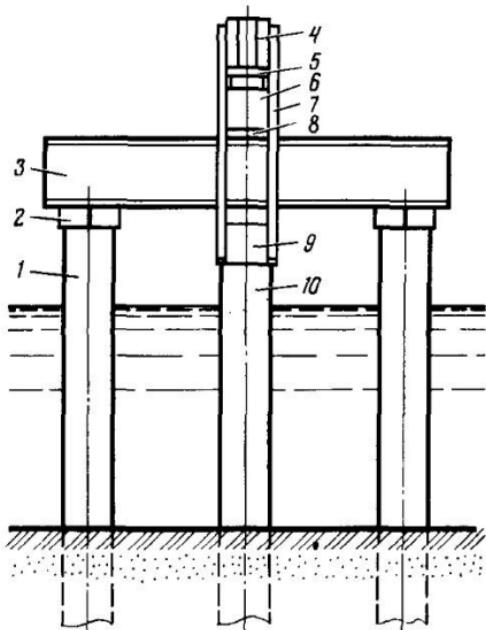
Установка для испытания выдергивающей нагрузкой свайного элемента:
